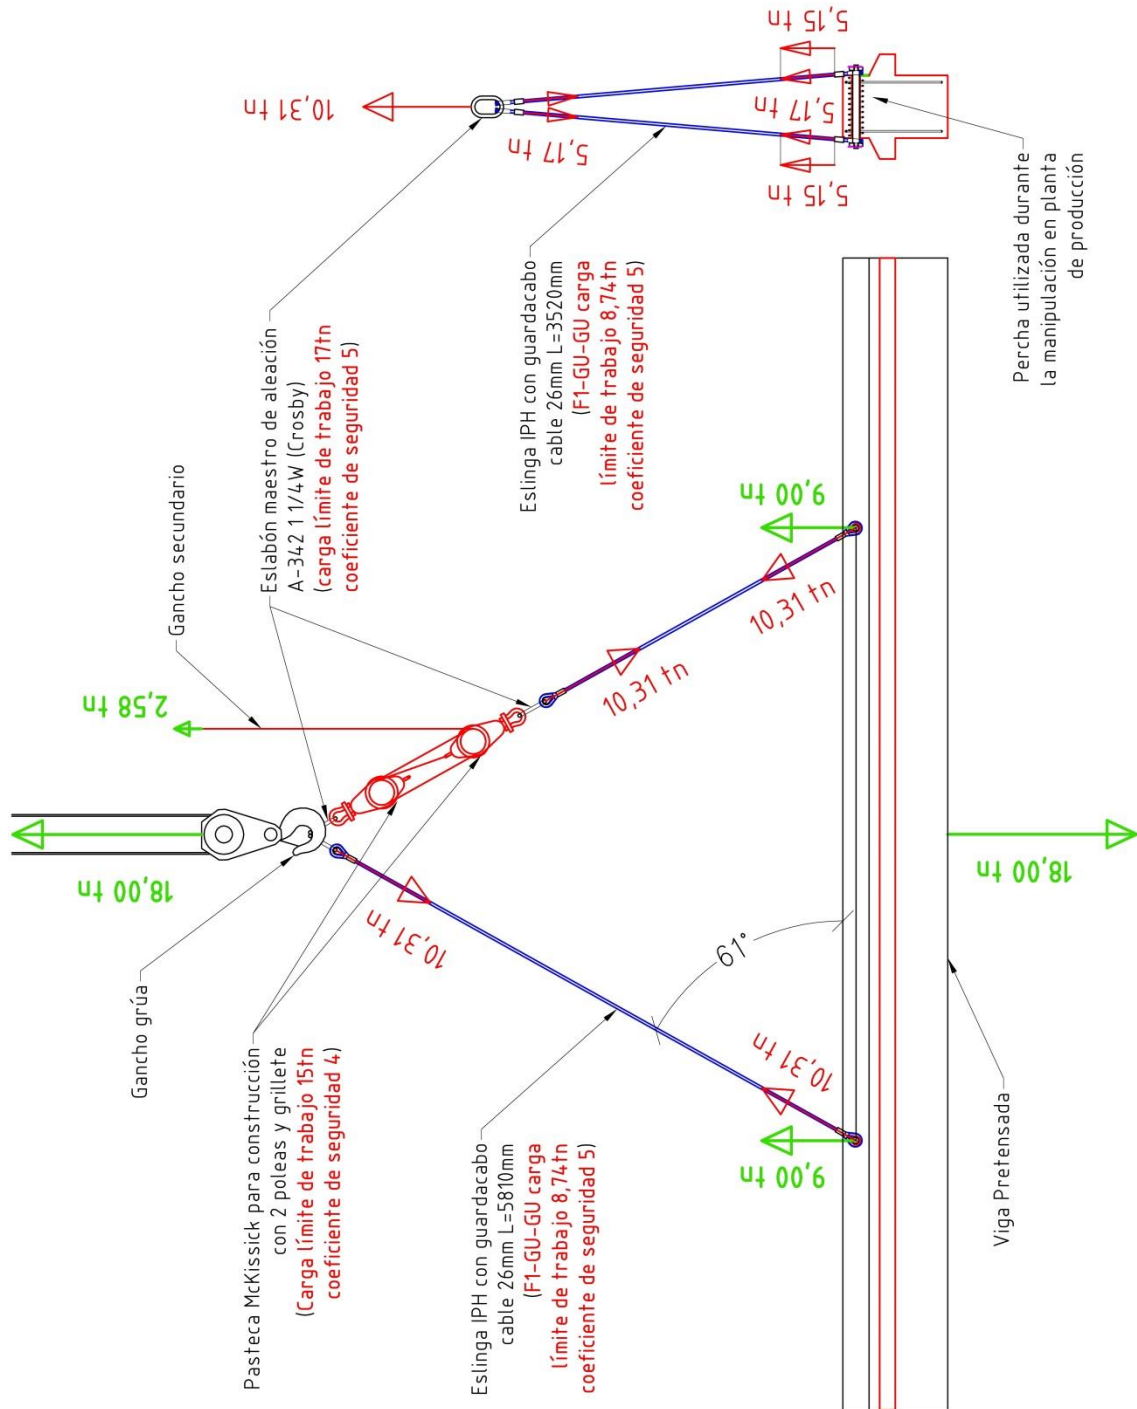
Elementos necesarios para el izaje y el giro de la viga – Posición a 0°
